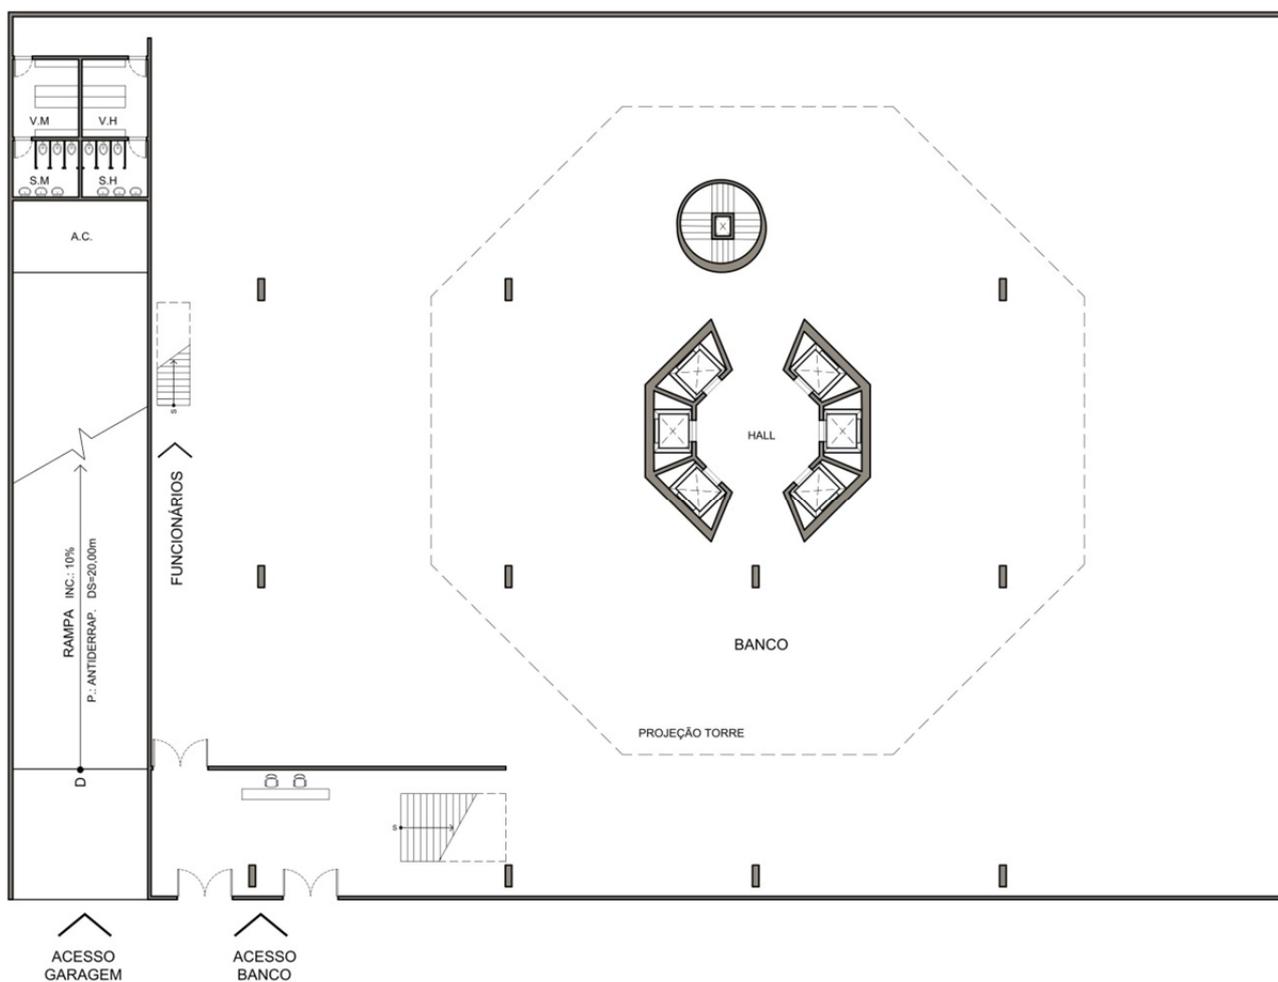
Planta do pavimento térreo inferior sede do Banco Safra
